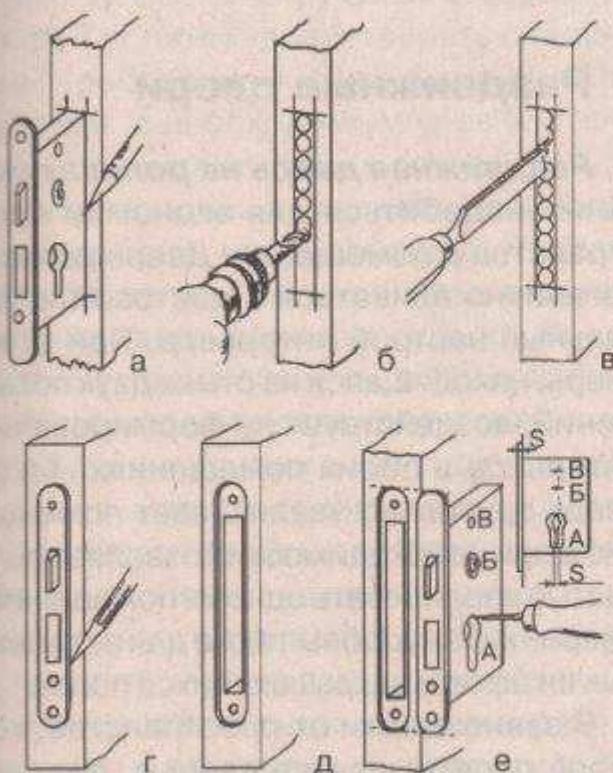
Врезка нового замка: а — нанесение разметки на торце деревянного полотна; б — сверление отверстий; в — чистка внутренней поверхности паза; г — разметка выемки для планки; д — выборка паза под планку; е — сдвиг разметки на толщину планки замка; А, Б, В — контуры отверстий
